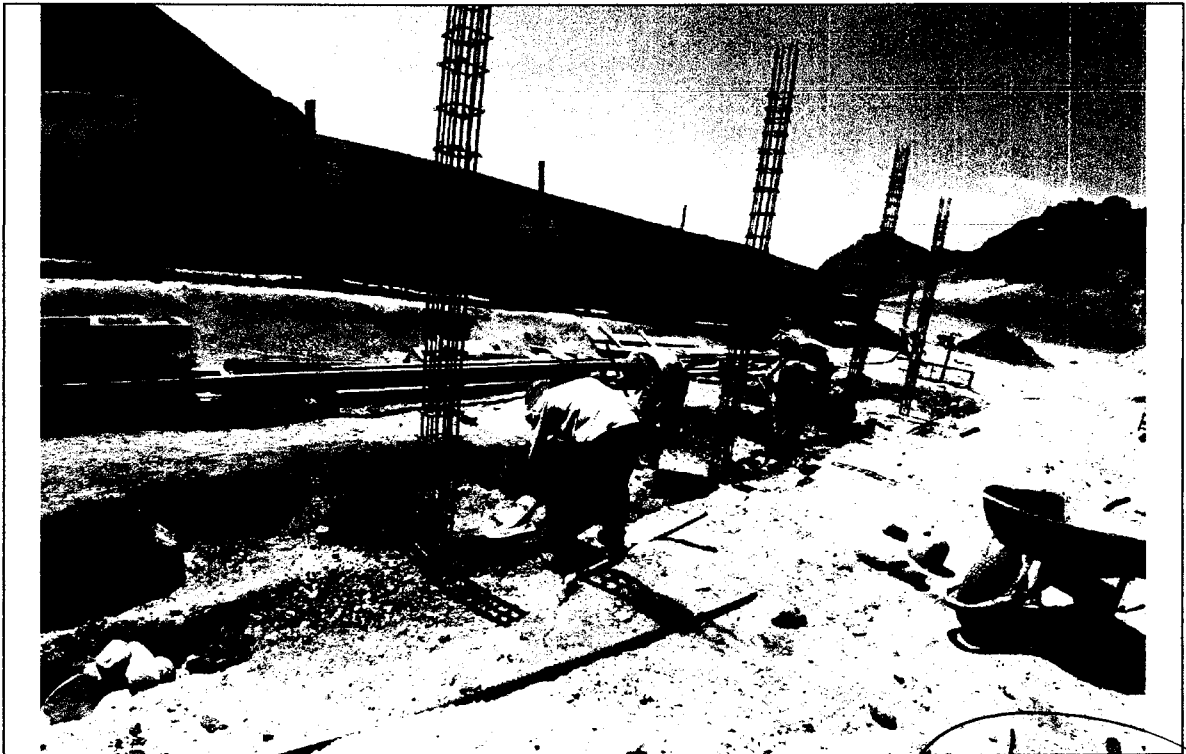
EXCAVACION DE FORMA MANUAL PARA VIGAS DE CIMENTACION.
